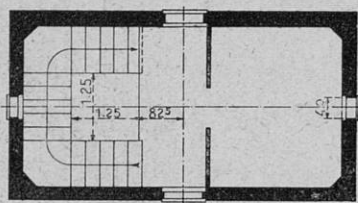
(éch. 0,007 p. m.). — Plan à la cote 7,55. — Les plans aux cotes 10,70, 13,85, 17,00 sont semblables.
